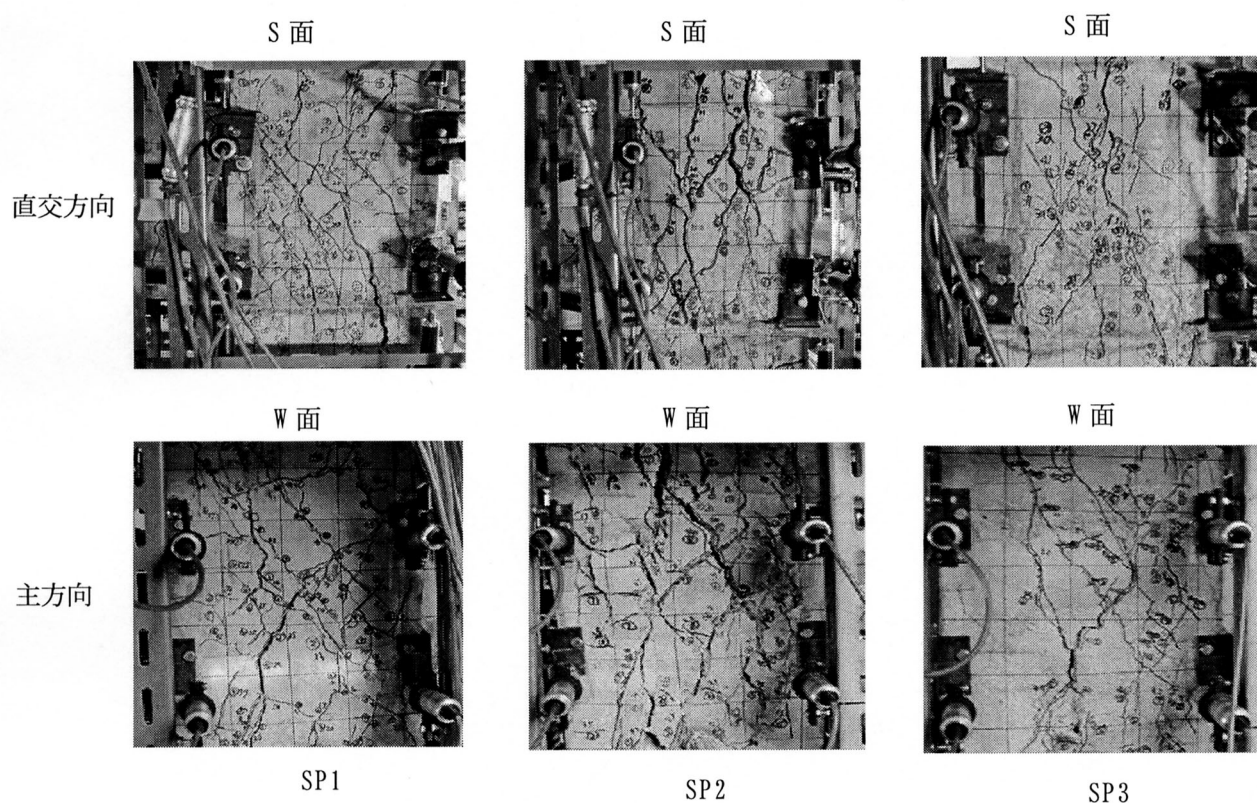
最大耐力時のせん断ひび割れ性状
